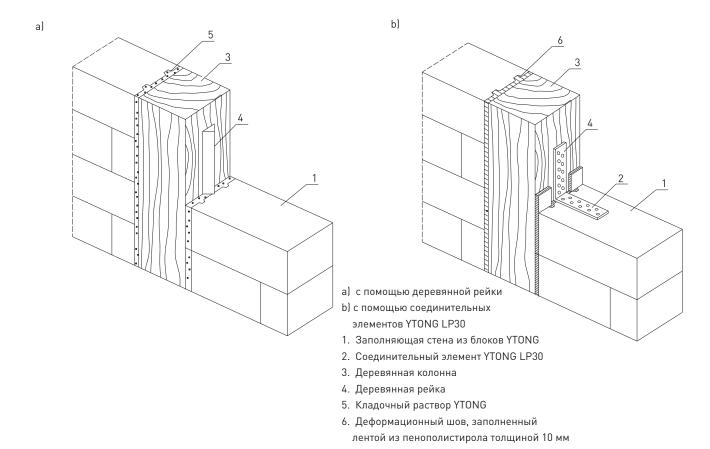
Соединение заполняющей стены из блоков YTONG с деревянной колонной
